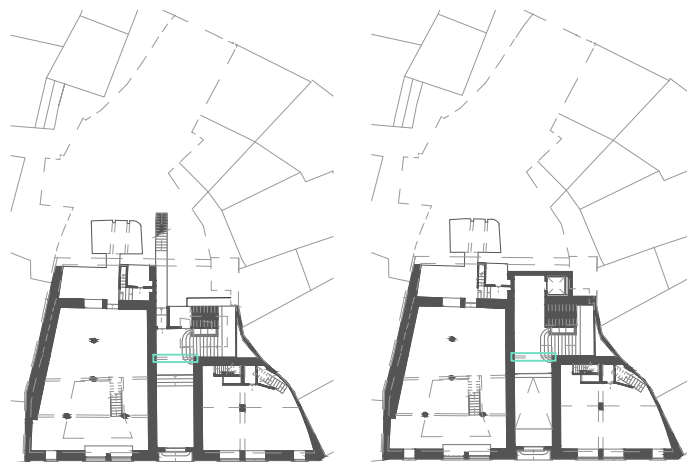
e 165 - Localização do Arco V1 na planta original (esquerda) e na planta de projeto (direita) - Escala 1:650
